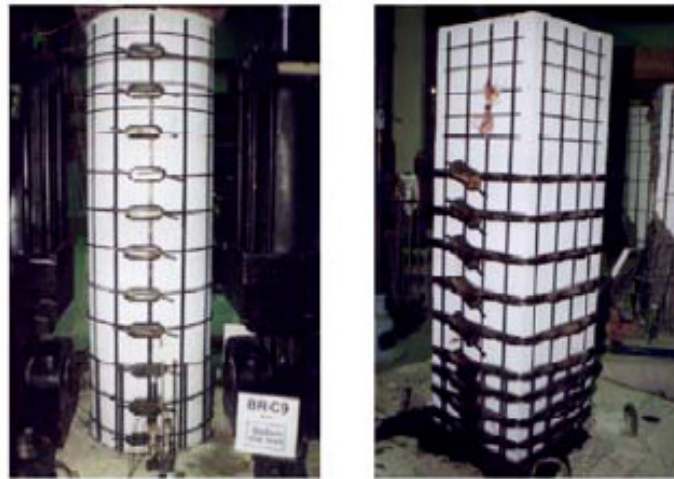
Aplicação de pré-esforço exterior de pilares (Silva, 2007).
